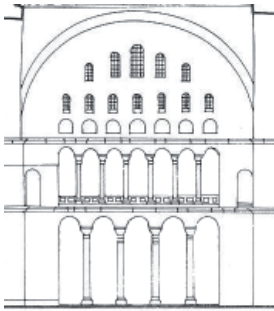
Alzado de la nave lateral de Santa Sofía. Discontinuidad en el número de columnas. Dibujo del autor sobre planimetría de Christian Norberg Schulz.
